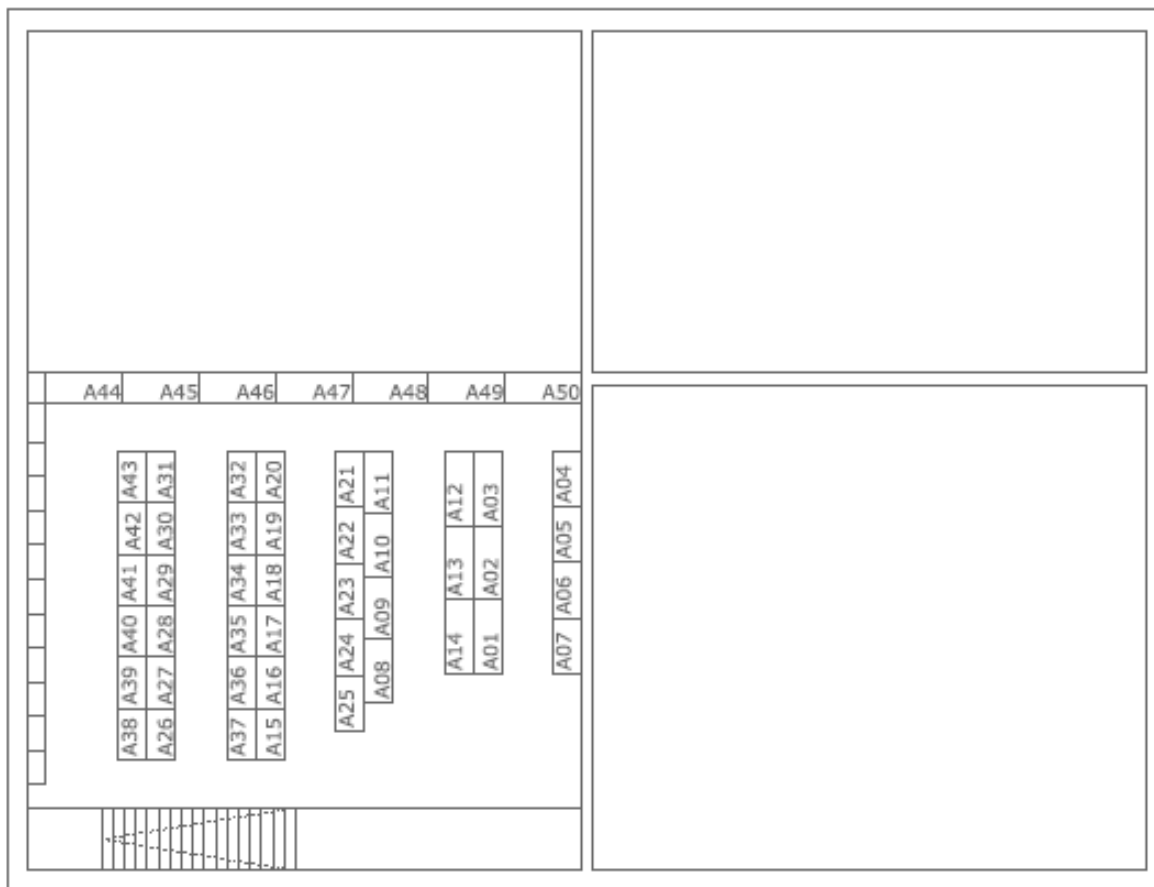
Layout del almacén después de la reforma. Planta Inferior.
